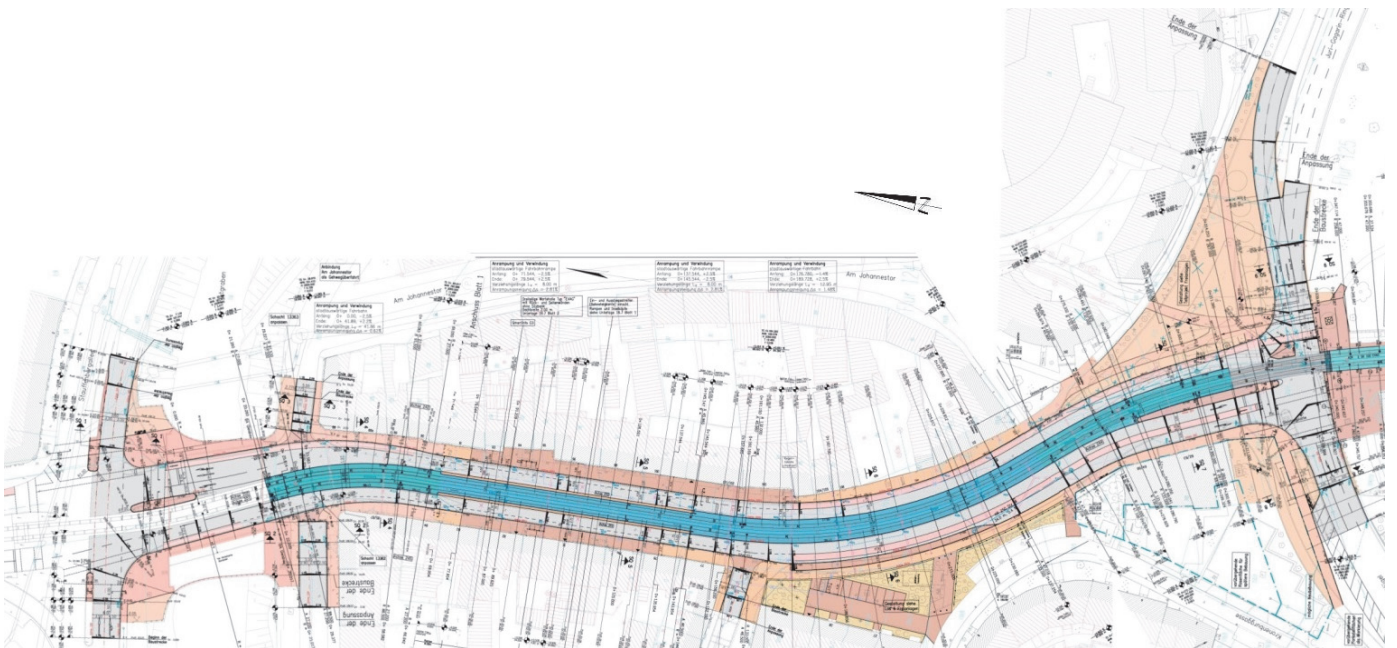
| Lageplan der neu gestalteten Johannesstraße: deutlich verringerte Verkehrsflächen im Knotenpunkt mit dem Stadtring und einstreifige Fahrbahnen mit Radfahrstreifen auf der Strecke, im Bereich der Stadtbahnhaltestelle auf einen Schutzstreifen reduziert
